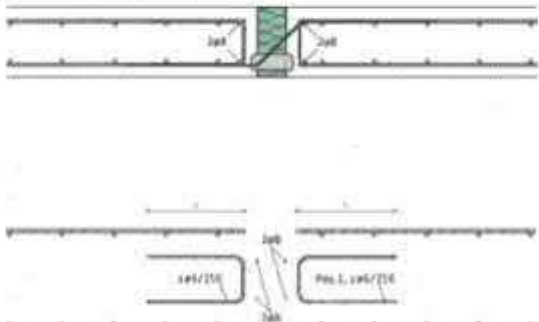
Bewehrungsführung Q bei indirekter Lagerung und deckenseitig geraden Querkraftstäben
